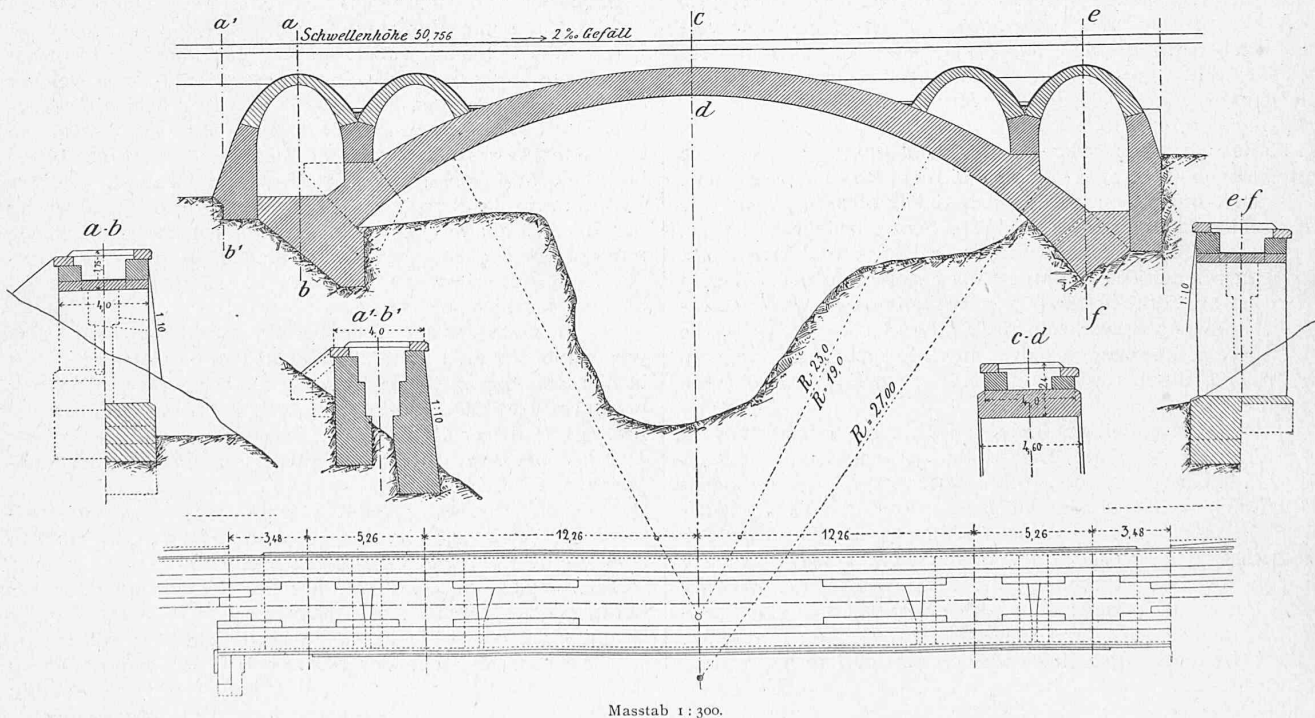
Längs-, Querschnitte und Grundriss der Betonbrücke.
